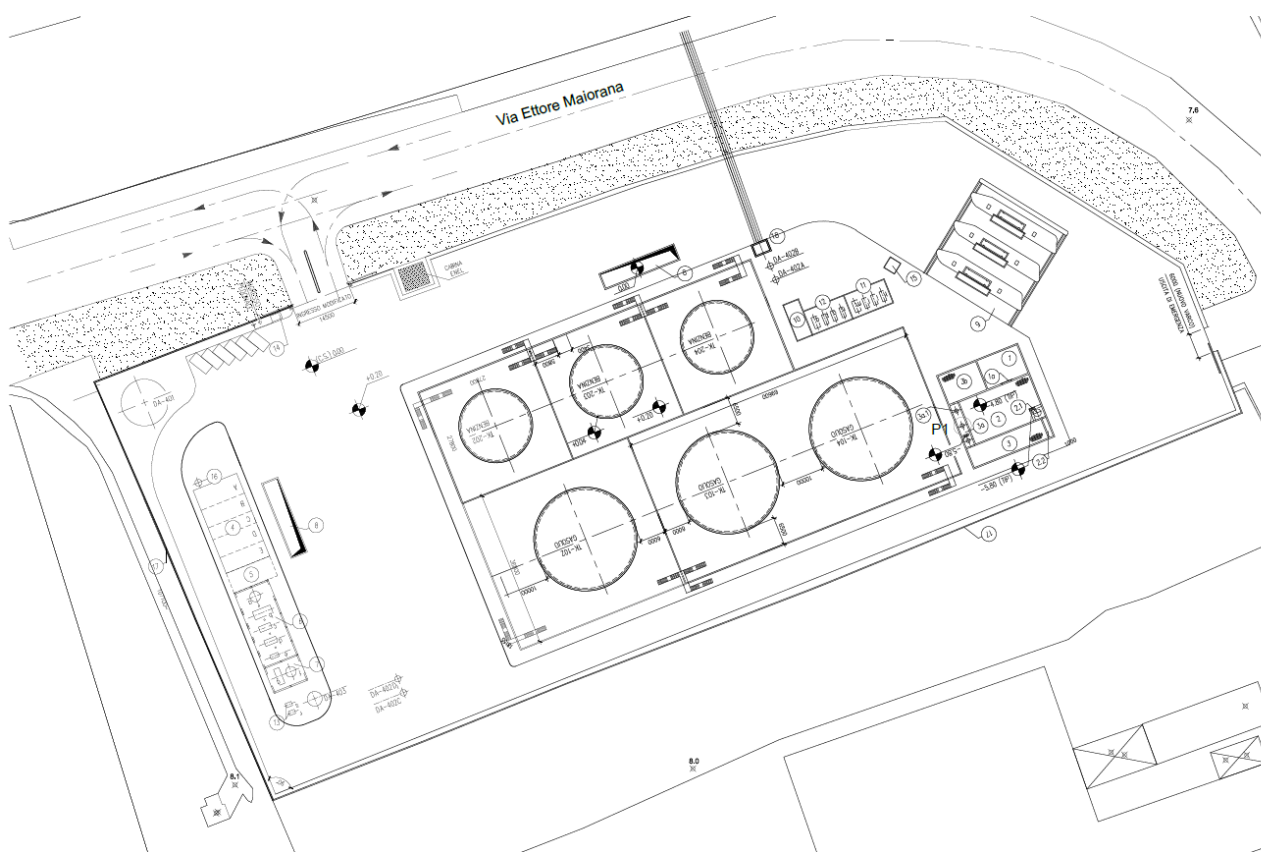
LAYOUT DI PROGETTO DEL DEPOSITO BRUNDISIUM
